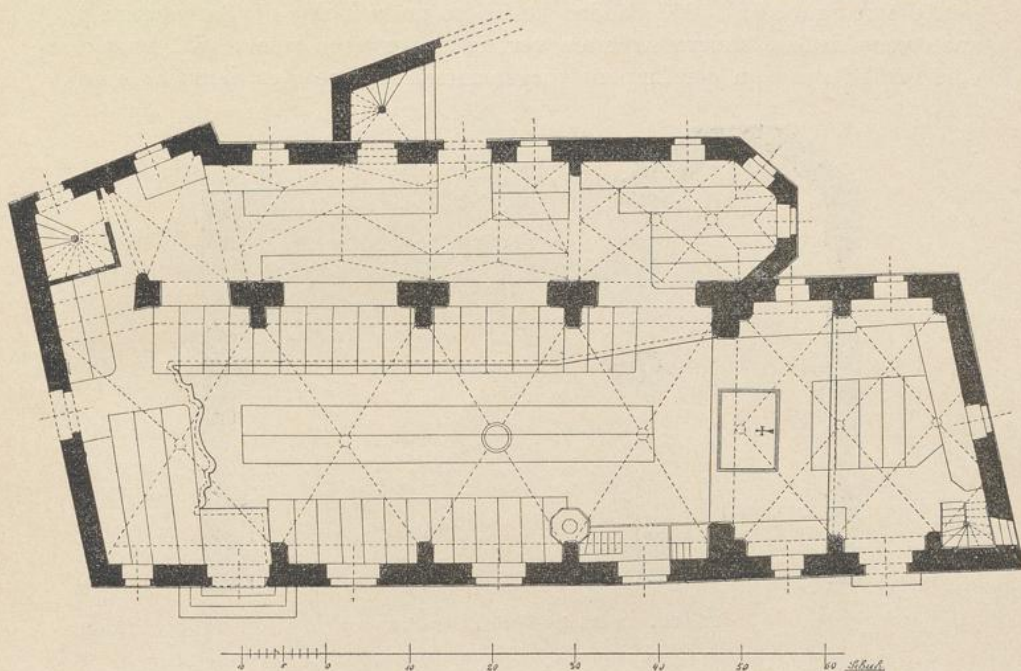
Dreikönigs-Kirche; Grundriss.
